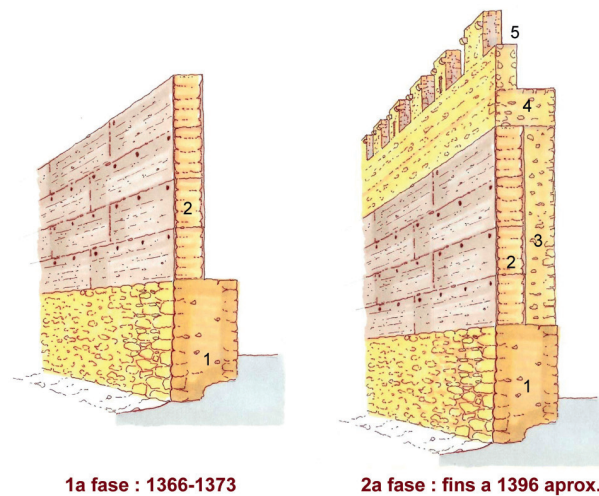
i 8b. Fases constructives de la muralla: fase 1 (1366-1374); fase 2 (1374-fins segles XIV).
